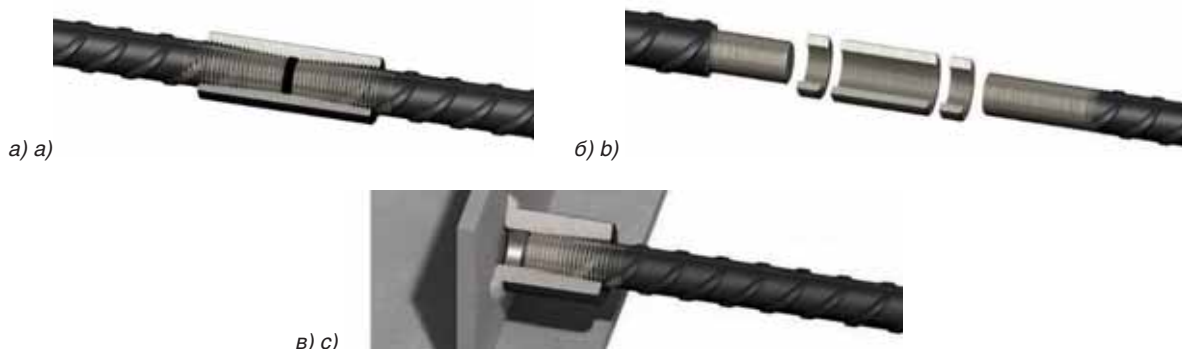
Резьбовые муфтовые соединения: а – с конической резьбой; б – с цилиндрической резьбой; в – приварная муфта
